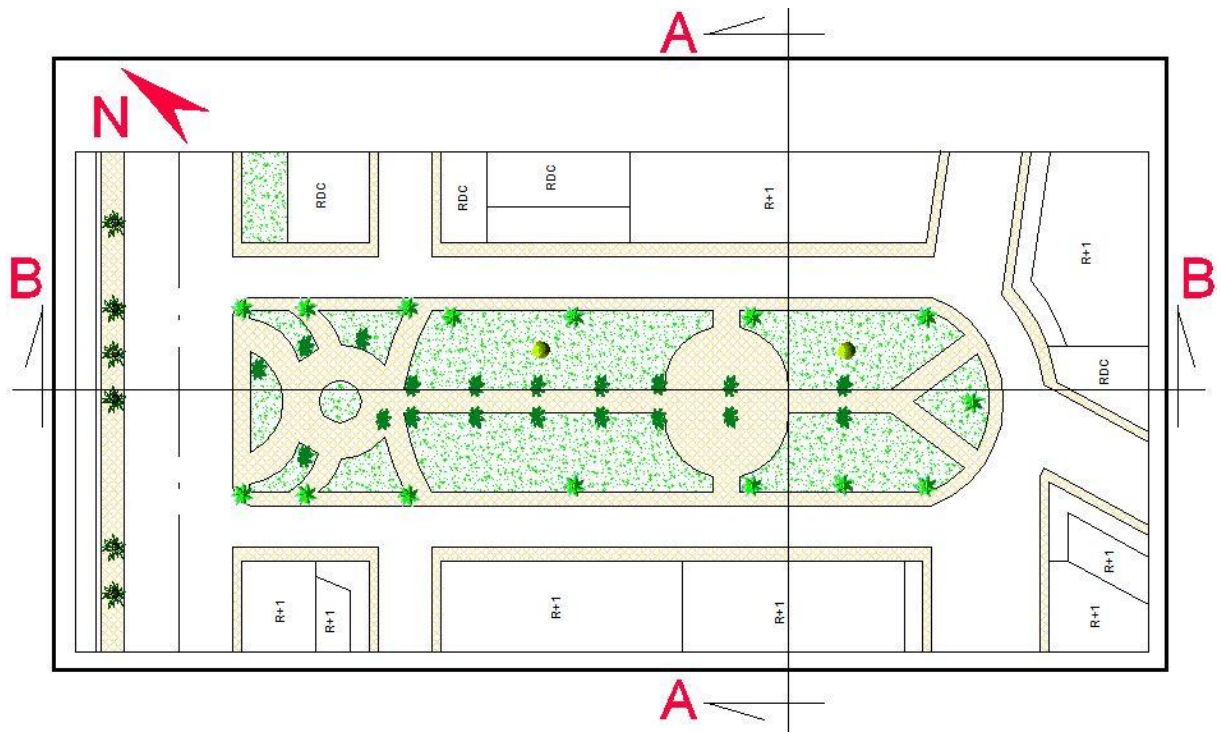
Choix des coupes sur le plan de la place de la cité Les Palmiers, dessiné sur Autodesk-Autocad.
